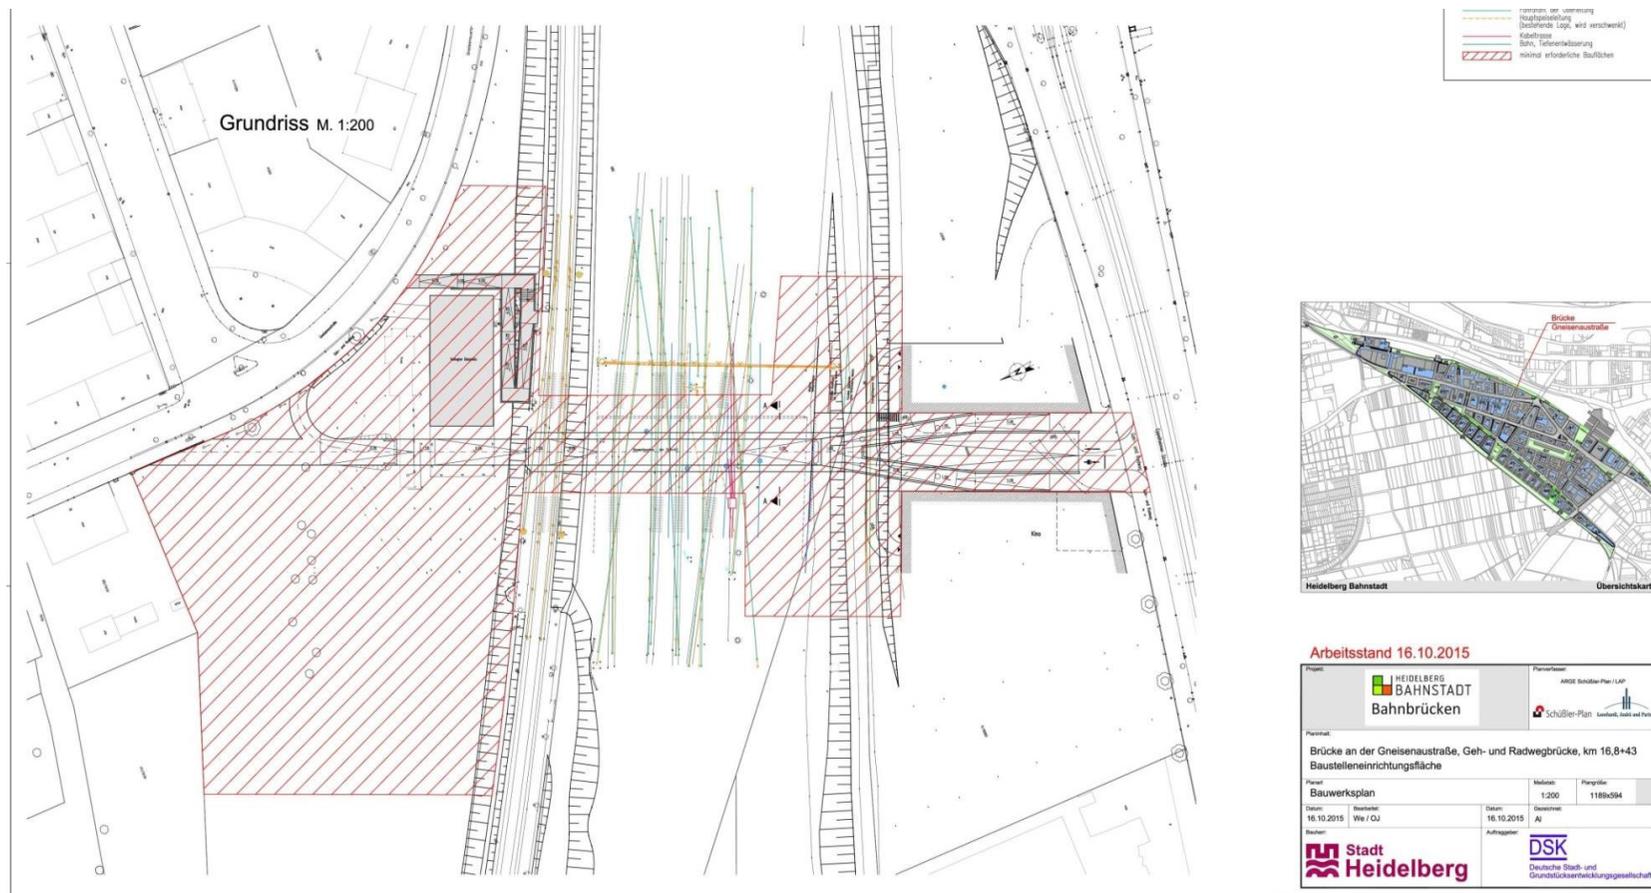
Baufläche einschließlich Baustelleneinrichtungsfläche
